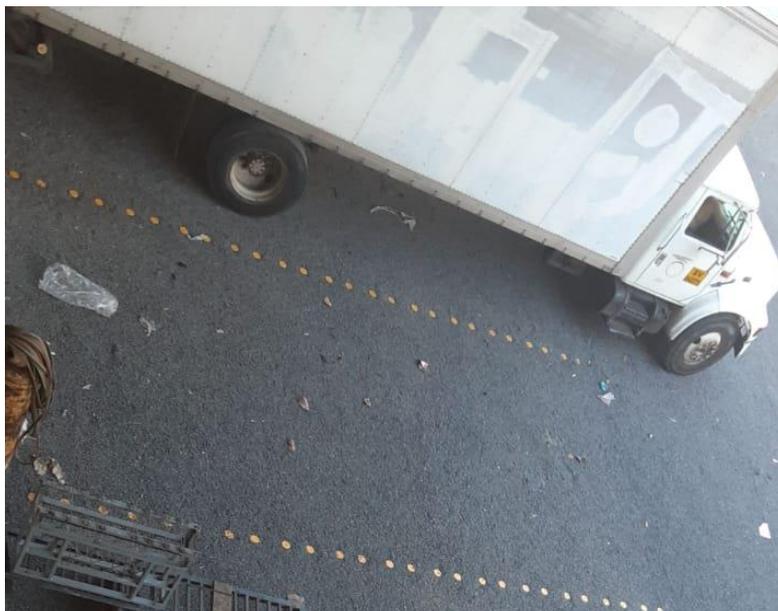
Sistema de pavimento permeable listo para su funcionamiento.
